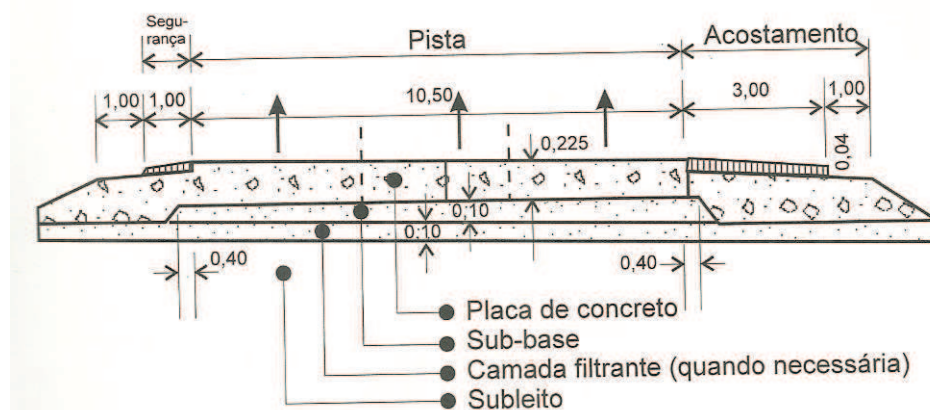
Seção transversal típica de uma pista de três faixas de tráfego – pavimento rígido. (Fonte: Senço, 1997)
